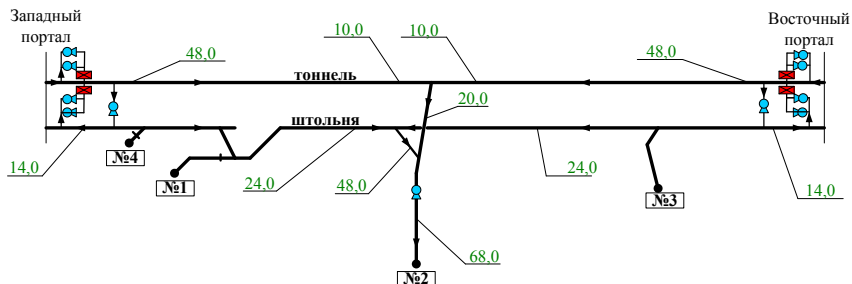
Проектная схема вентиляции тоннеля, штольни с необходимыми расходами воздуха
